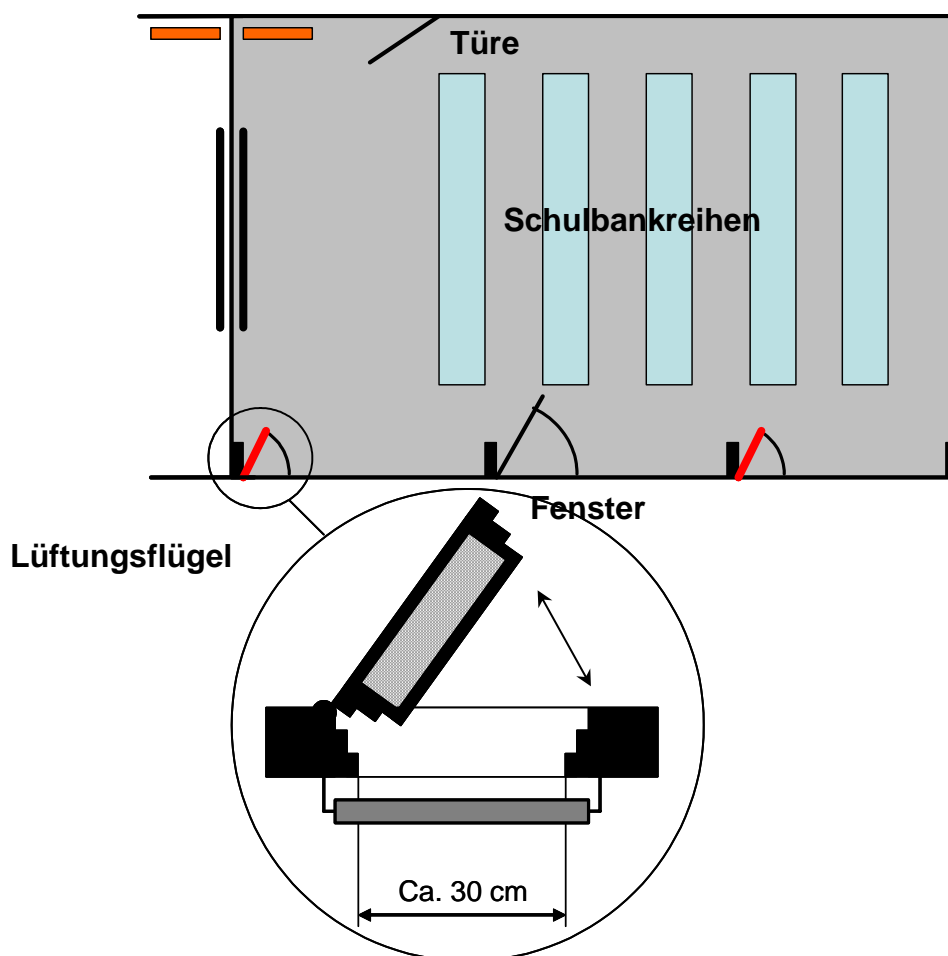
Grundriss eines Unterrichtszimmers und Vergrößerung des Lüftungsflügels mit Wetterchutzlamellen davor
